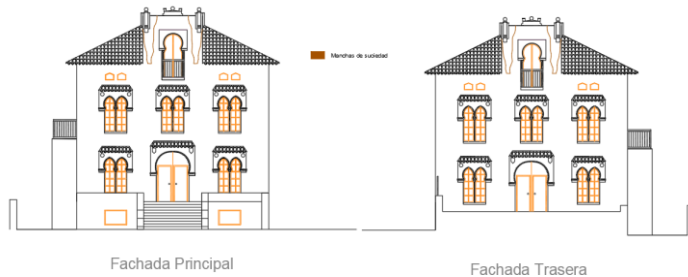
Plano de alzado de fachadas con la patología. Fuente: CAD Propio
